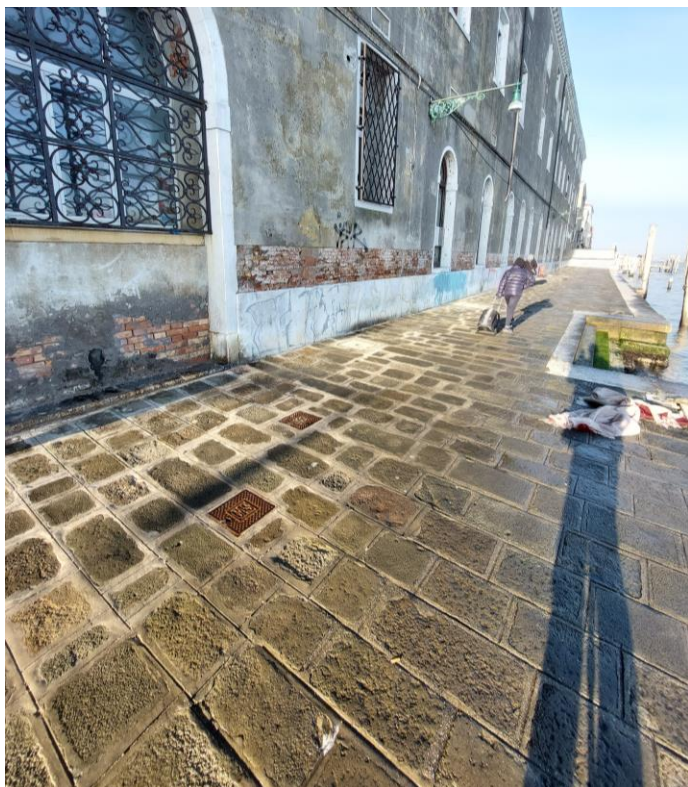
Vista del tratto di Fondamente Nove tra ponti dei mendicanti e della Cavana
